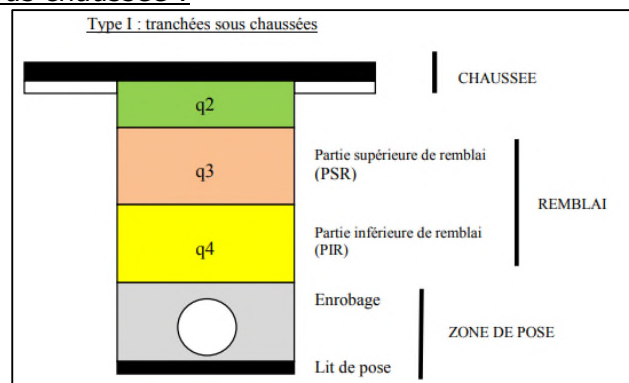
Schéma détaillé d'une tranchée de type I : tranchée sous chaussée
